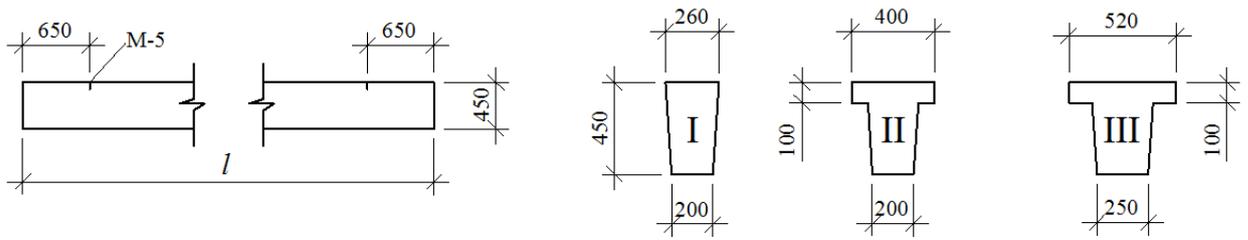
Балки фундаментные: конструкция балок, детали опирания балок
